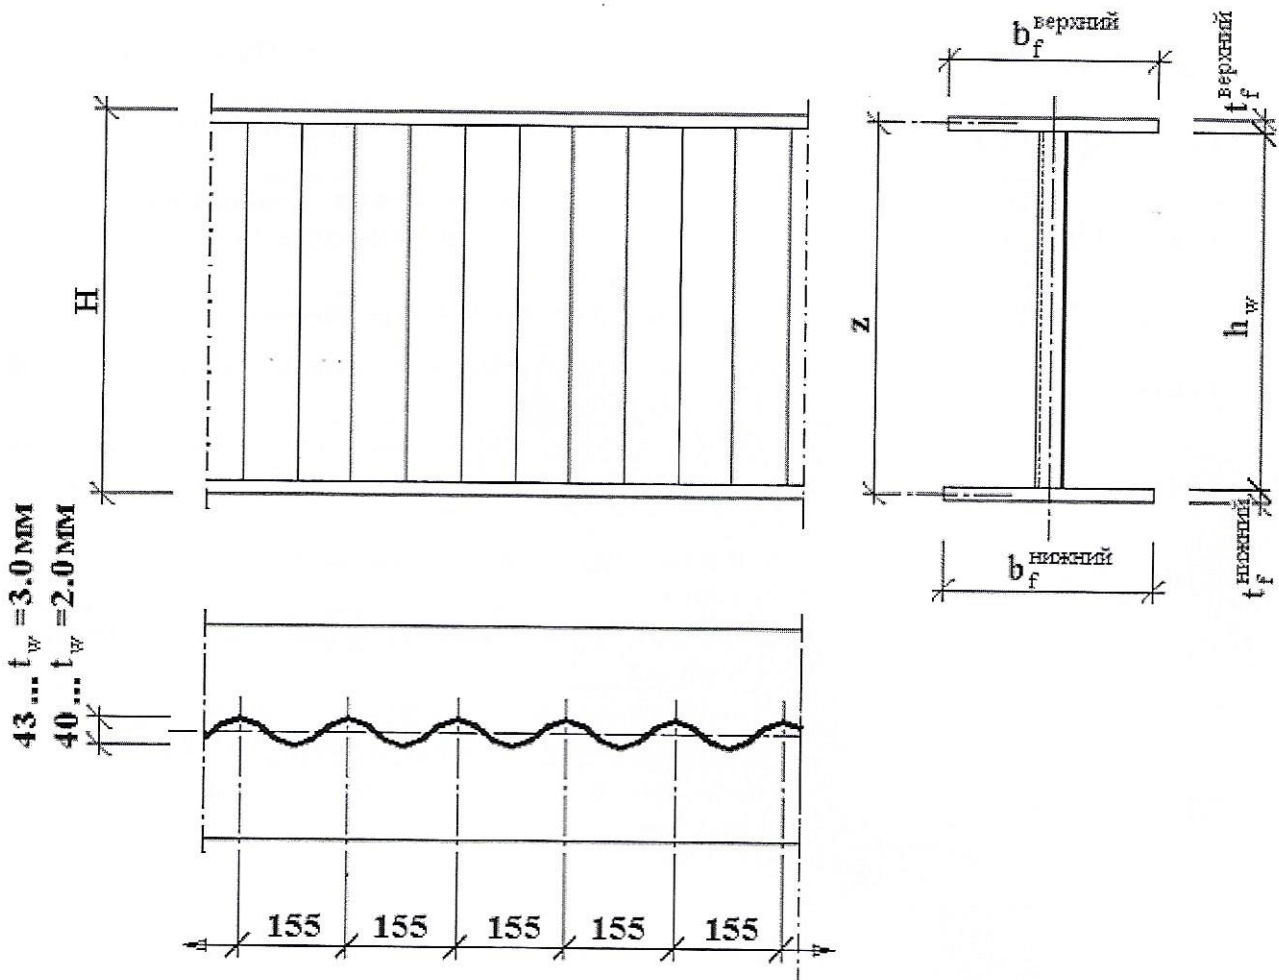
Схема сварной балки двутавровой с поперечно гофрированной стенкой с волнистой формой гофра
